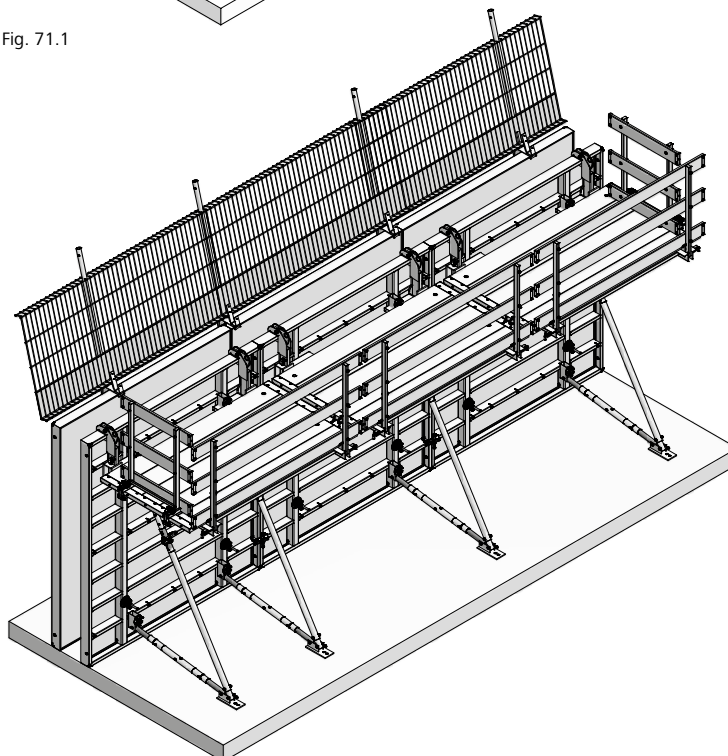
Coffrage deux faces avec étais et plate-forme de travail sur coffrage extérieur
